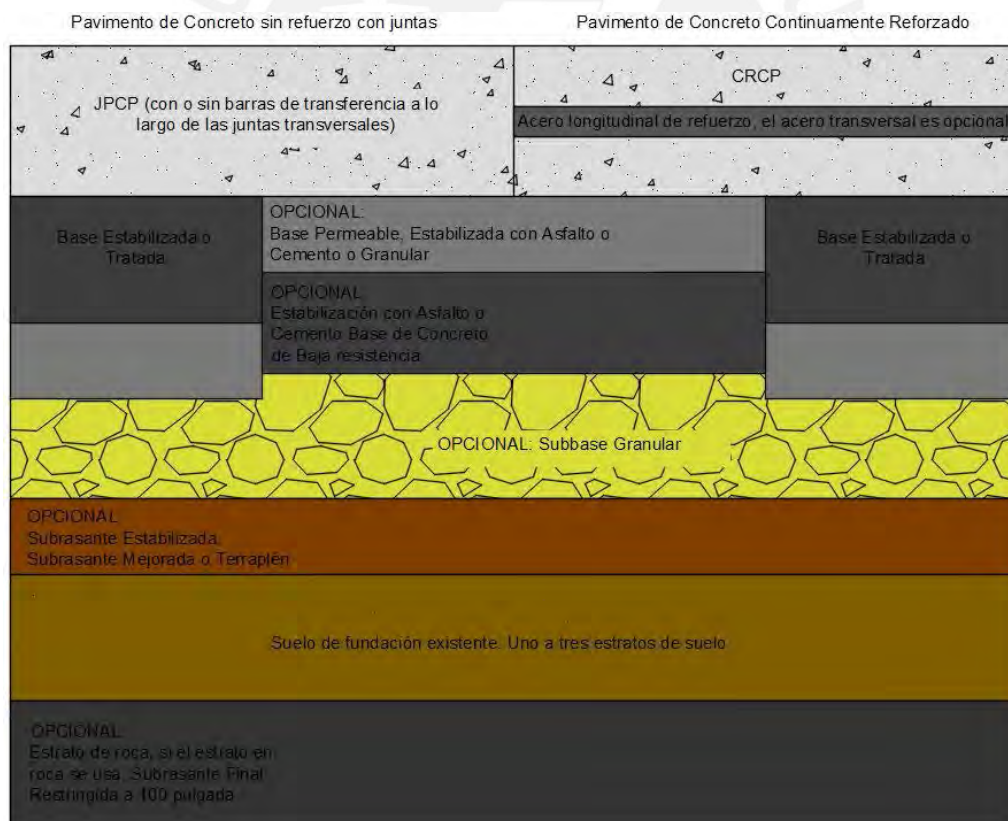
Estructuras de pavimento rígido nuevo en el MEPDG.
